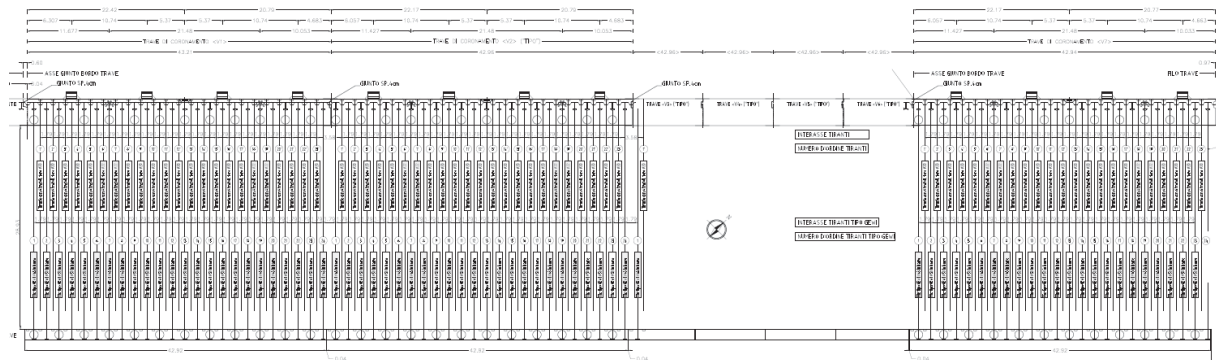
Estratto da PE di Variante - Tav.02 - Stralcio planimetrico con ubicazione arredi di banchina
